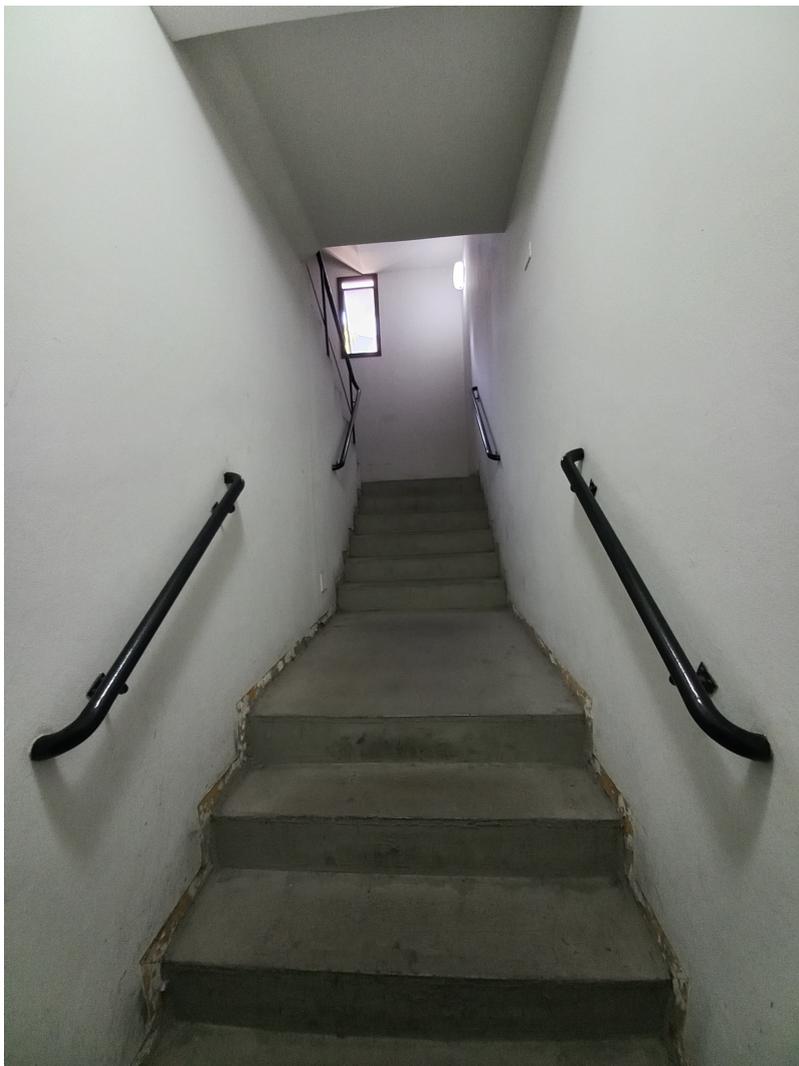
Corrimãos do Pavimento Térreo, é importante mencionar que será diferente dos demais pavimentos.
